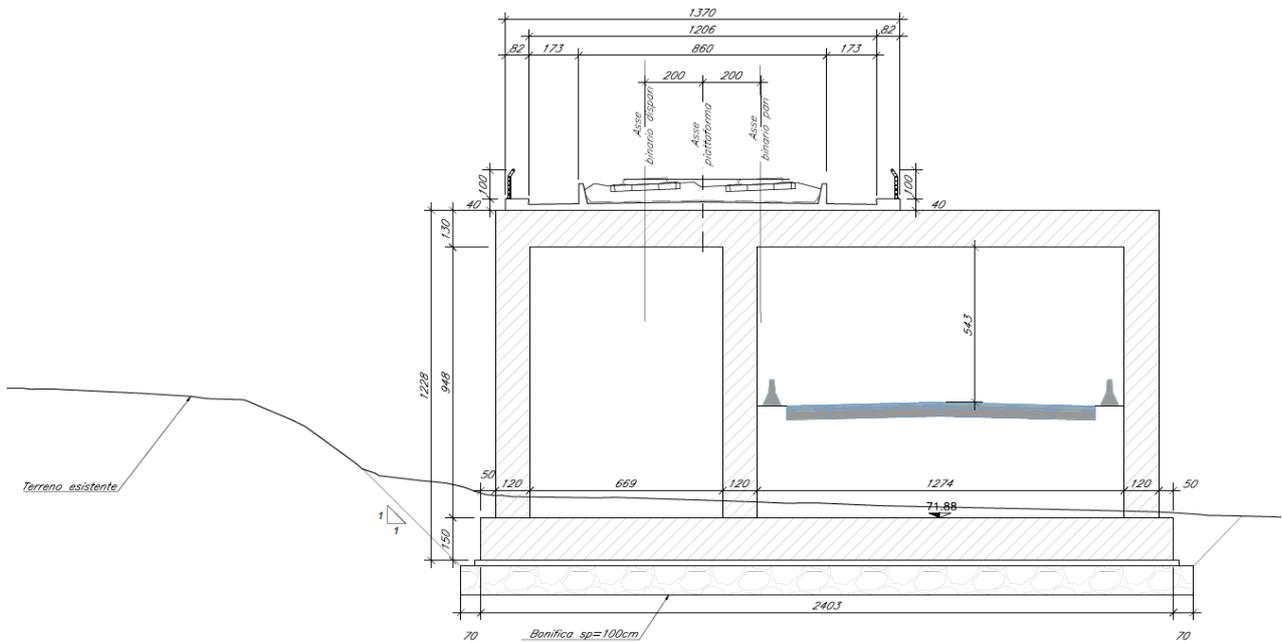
SL21 – Sezione trasversale in asse ferrovia
